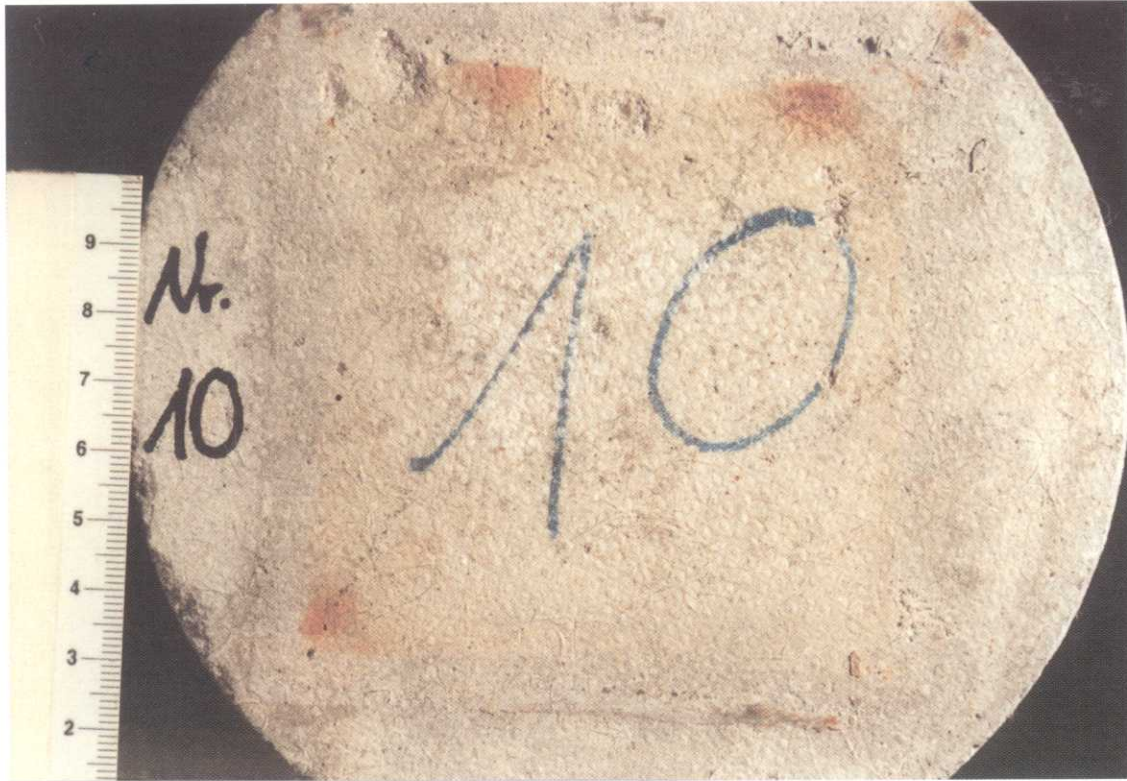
wie Foto 13, jedoch Betonoberfläche unter Verwendung der ZEMDRAIN-Schalungsbahn hergestellt.
